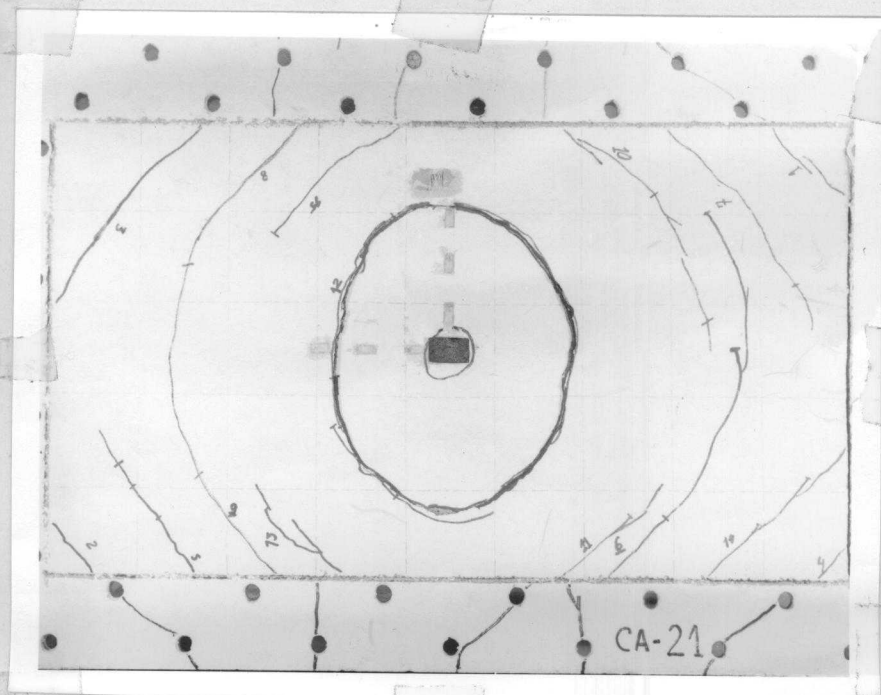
Configuração de ruína (face superior) da laje CA-21.
